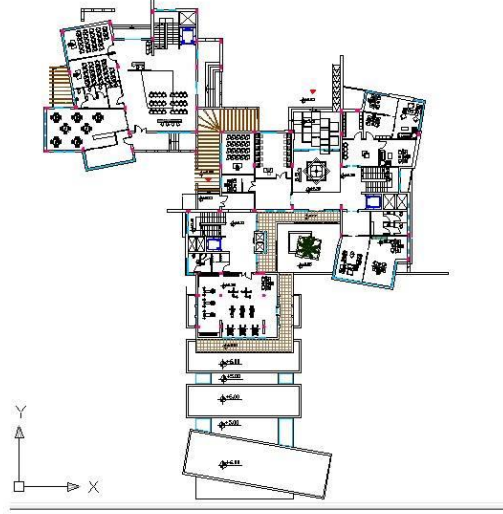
المسقط الأفقي للطابق الأرضي.
